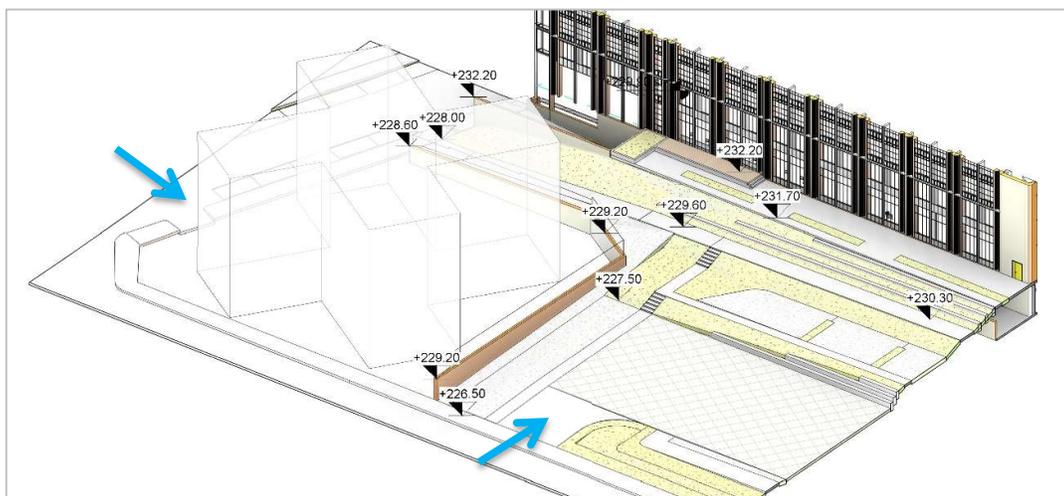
Vista prospettica dello stato di progetto con individuazione potenziali vie di accesso dell'acqua
